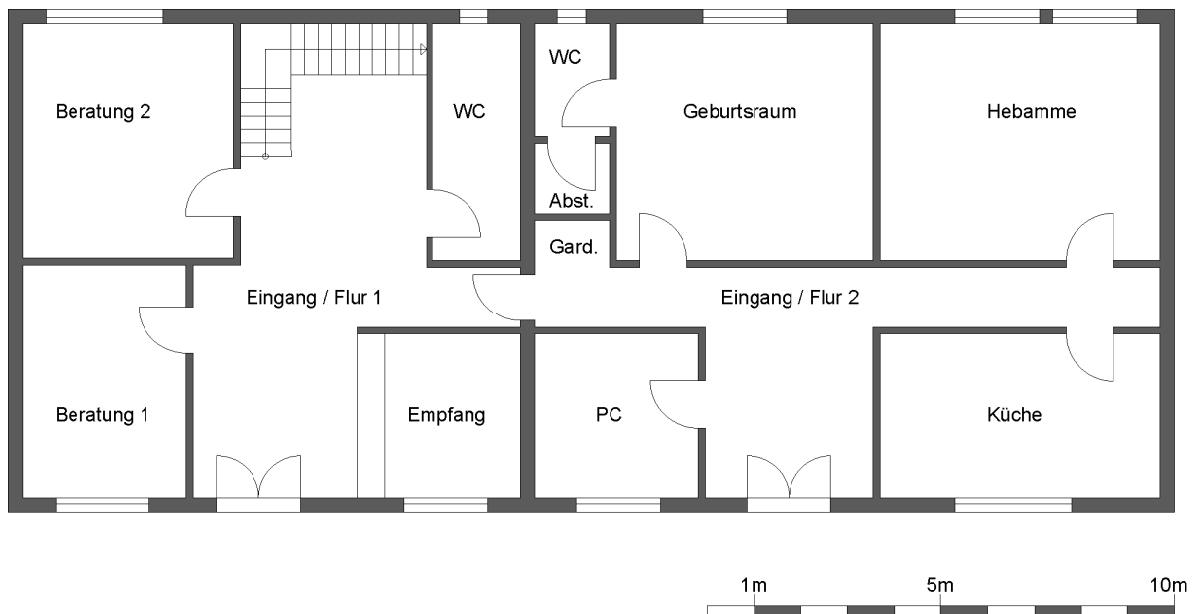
Grundriss Erdgeschoss Geburtshaus Dresden
